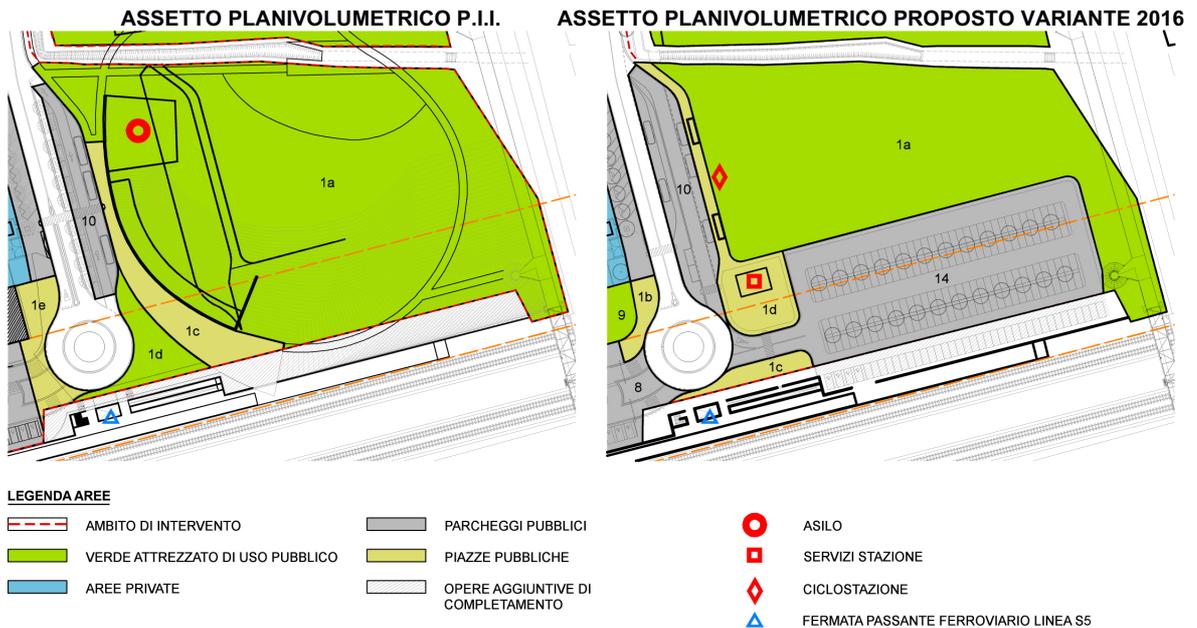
| Confronto tra la planimetria di P.I.I. e variante 2016.
